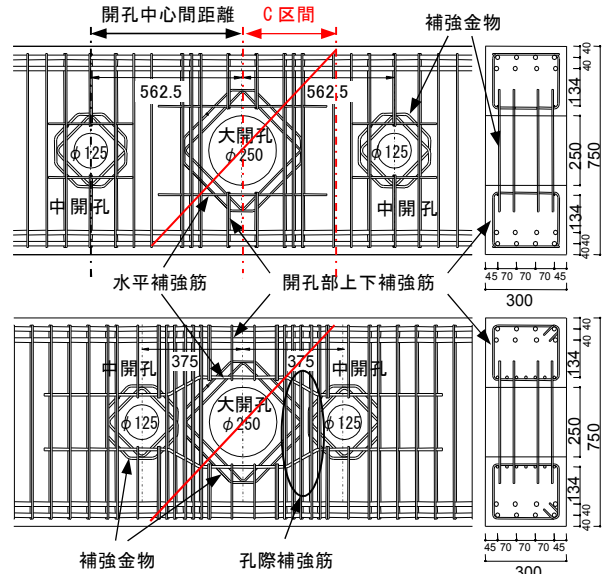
配筋図 (上: 試験体 No.1, 下: 試験体 No.3)
